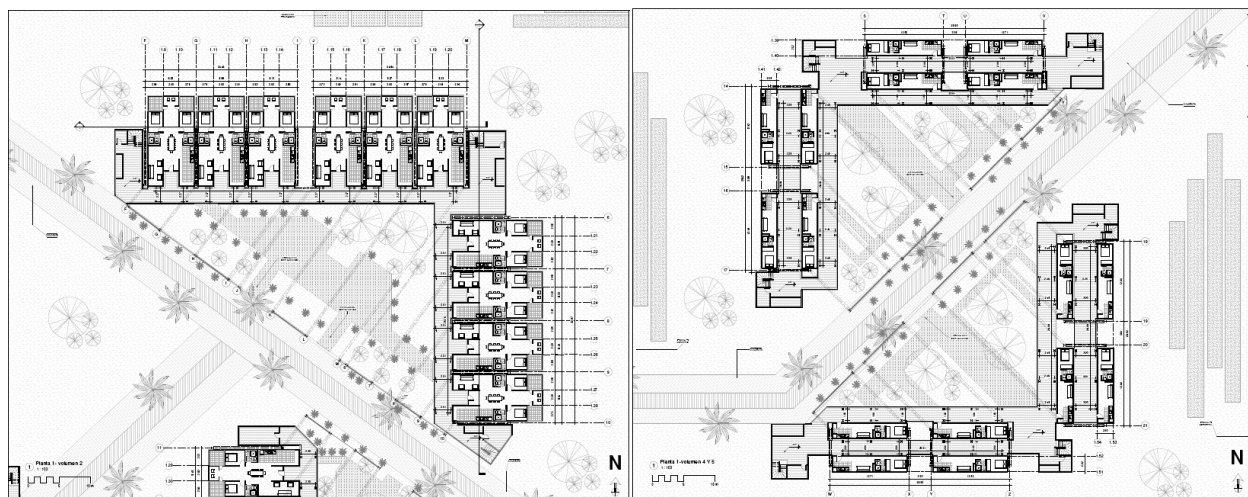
Anexo de planta de primer piso del volumen 2 y 3 - Fuente propia.
